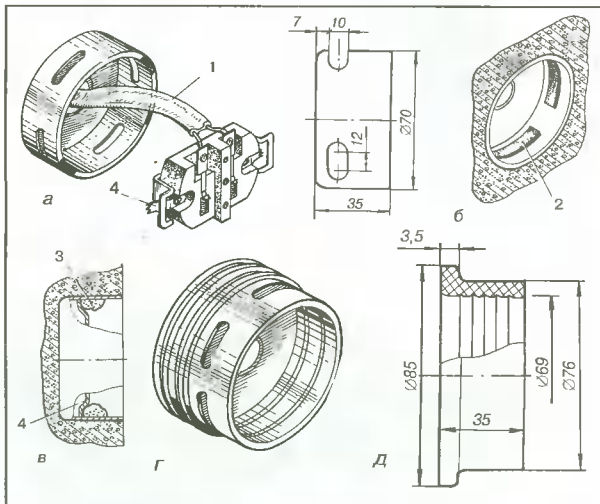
Крепление розеток скрытого исполнения: а — в жестяной установочной коробке типа У196; б, в — в бракованной установочной коробке; г — в пластмассовой установочной коробке типа ЛВ1УХЛЗ; д — в установочном пластмассовом кольце типа ЛВ03ХЛ2. 1 — провод; 2 — полоска листового резины; 3 — выступ из раствора; 4 — стопорная лапка;
